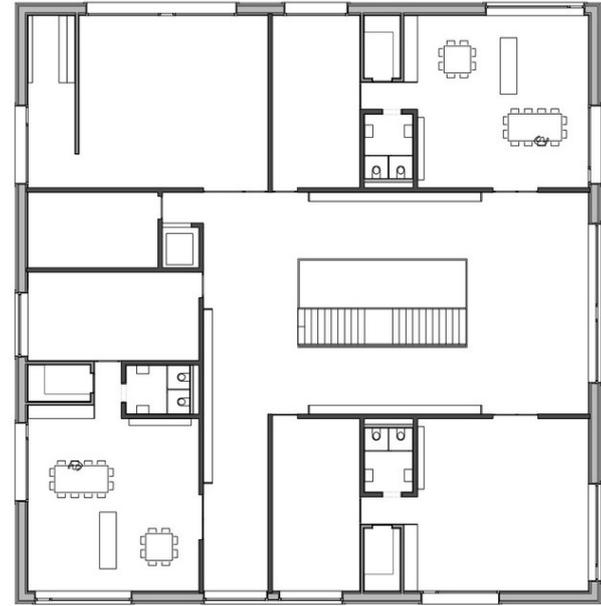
Kindergarten Susi Weigel, Grundriss OG
